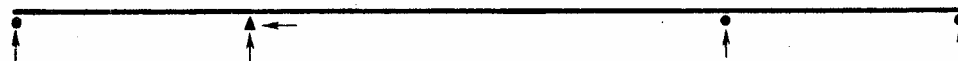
Балочное неразрезное пролетное строение моста через водоток
